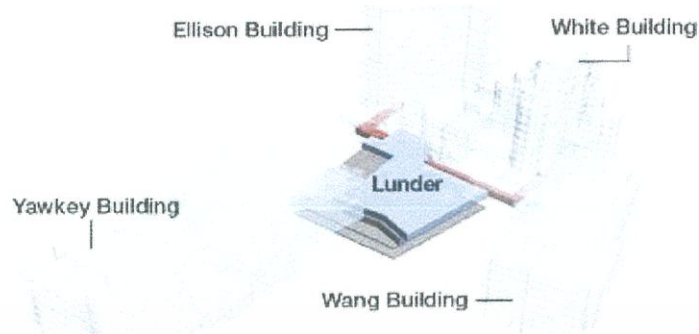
แสดงทัศนียภาพ Lunder Building, Massachusetts General Hospital
